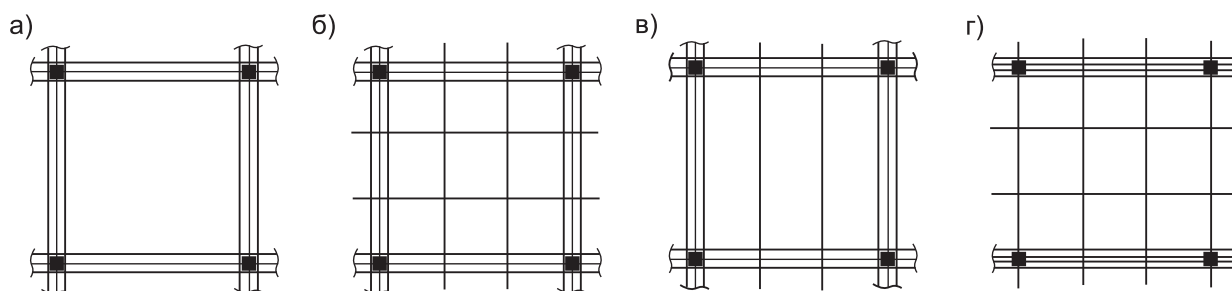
Характерные схемы размещения напрягающих элементов в плане перекрытия при регулярной сетке колонн
